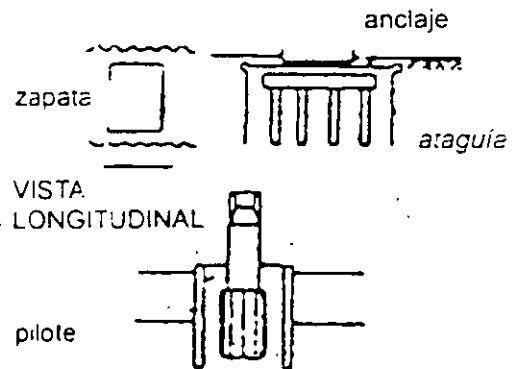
REFORZAMIENTO SISMICO PARA CIMENTACION DE PILAS
